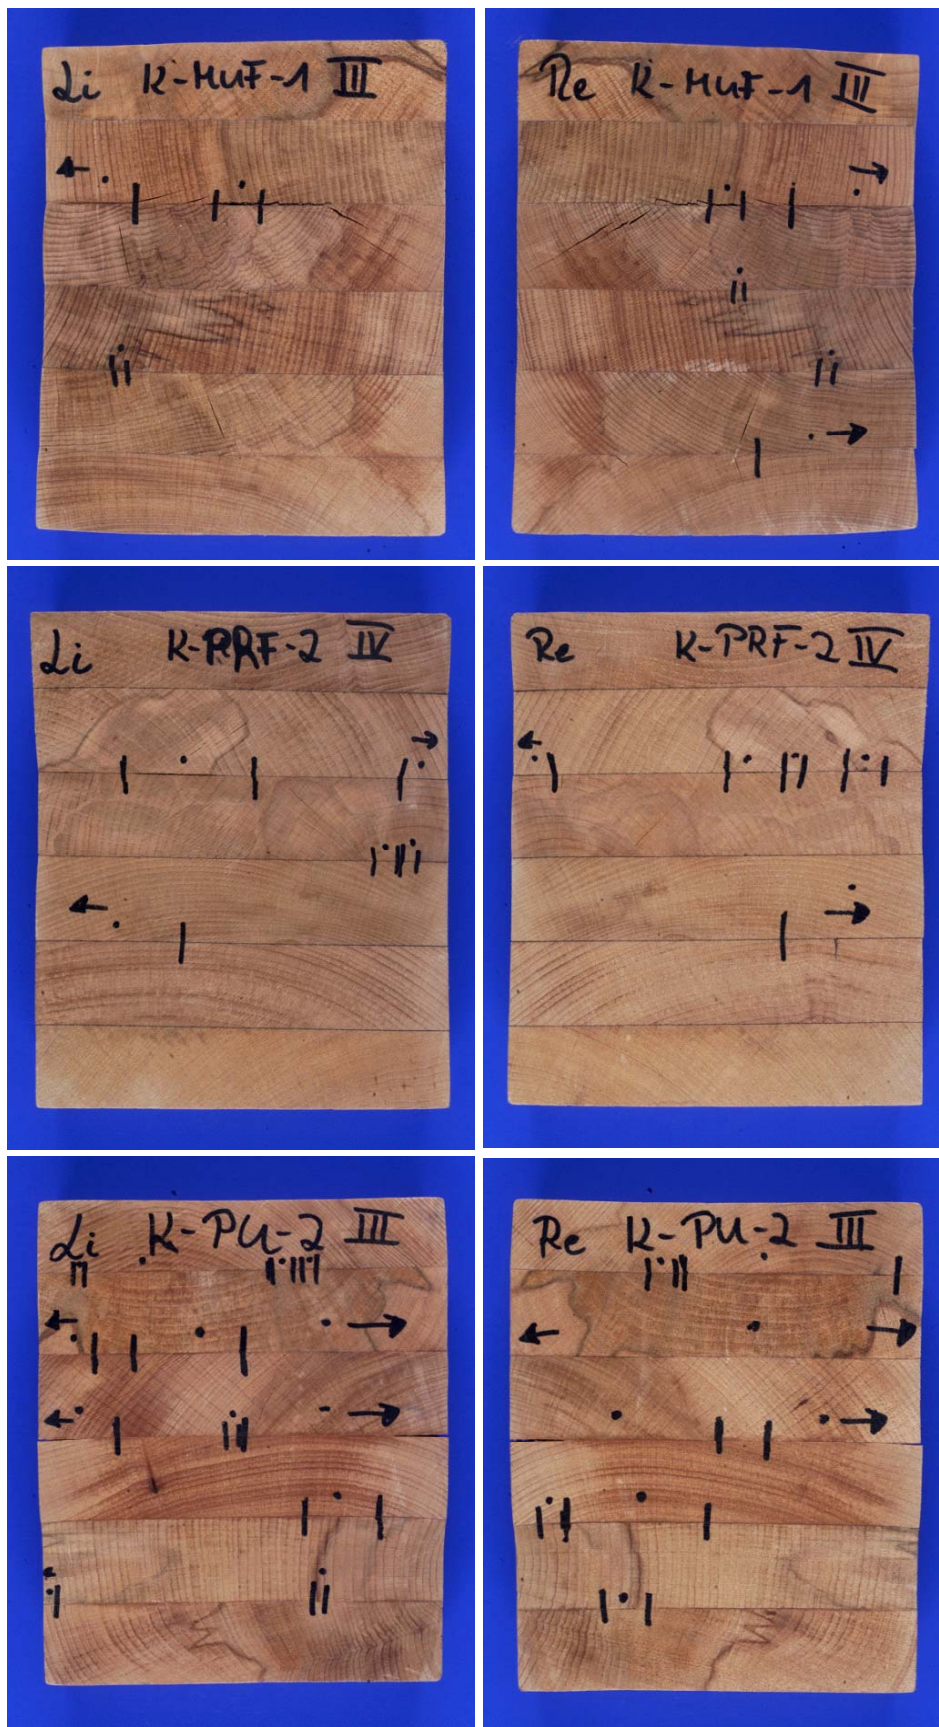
Delaminierte Prüfkörper (Lamellenstärke 30 mm)
